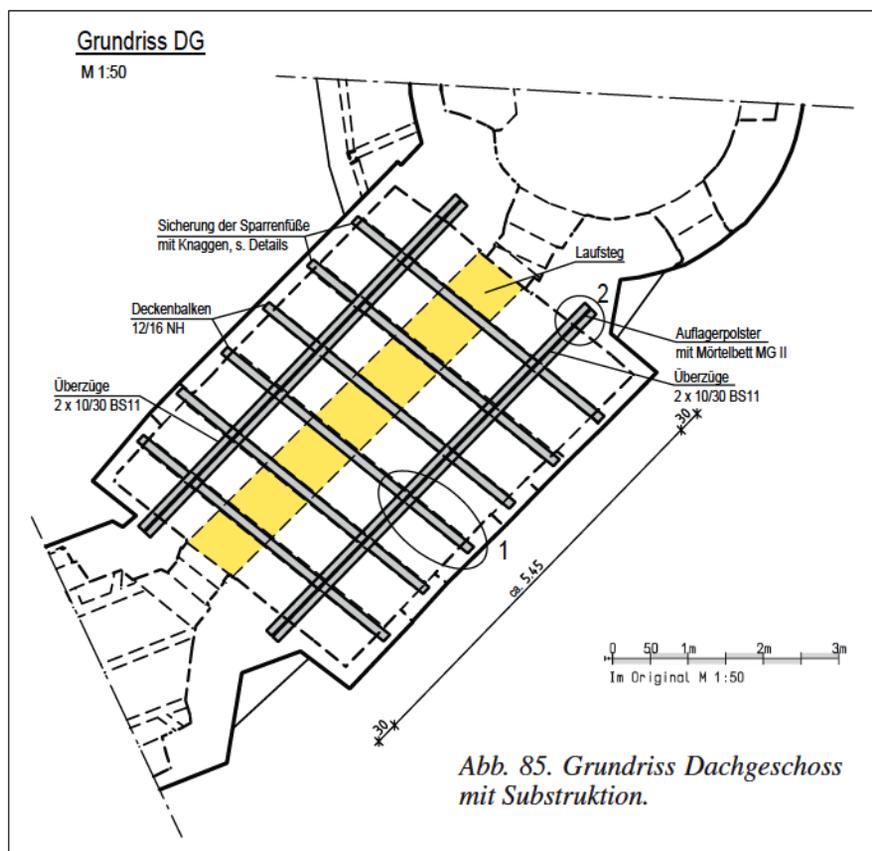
Grundriss Dachgeschoss mit Substruktion.
